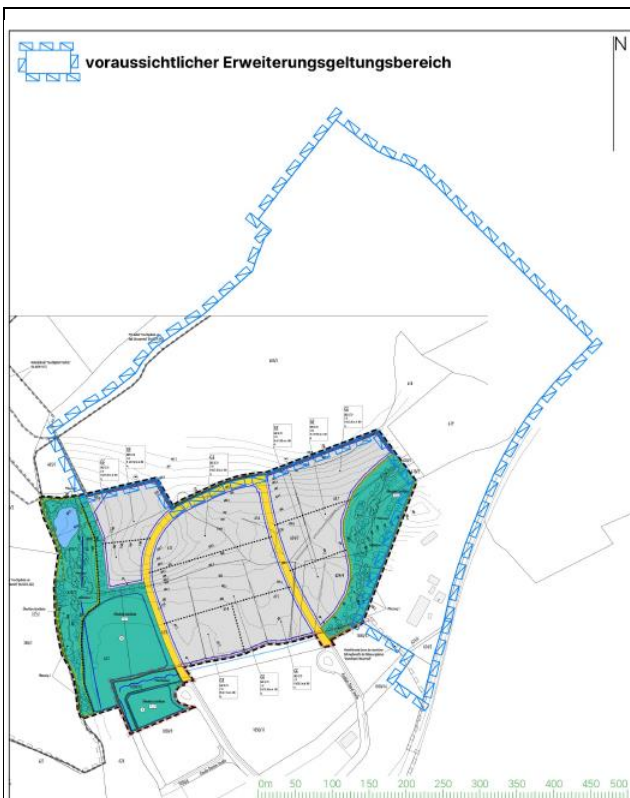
voraussichtl. Geltungsbereiche des BPlans "Gewerbepark Wasserstall" mit ca. 21.87 ha
